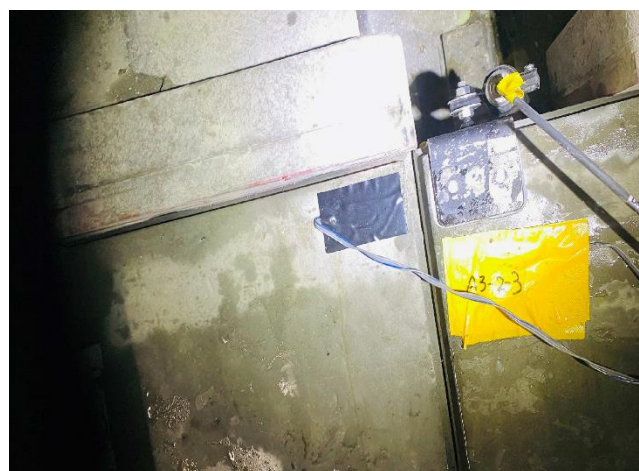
ひずみゲージ・鉛直変位計 設置状況
